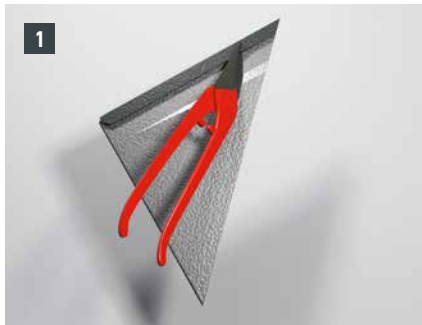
· Einfassung Dachflächenfenster – Besonderheit bei Dachraute 29×29 und 44×44
